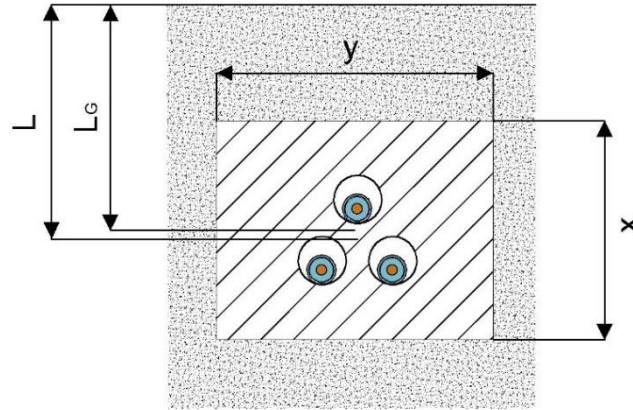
Representación de una instalación de cables bajo tubo en bloque de hormigón.
